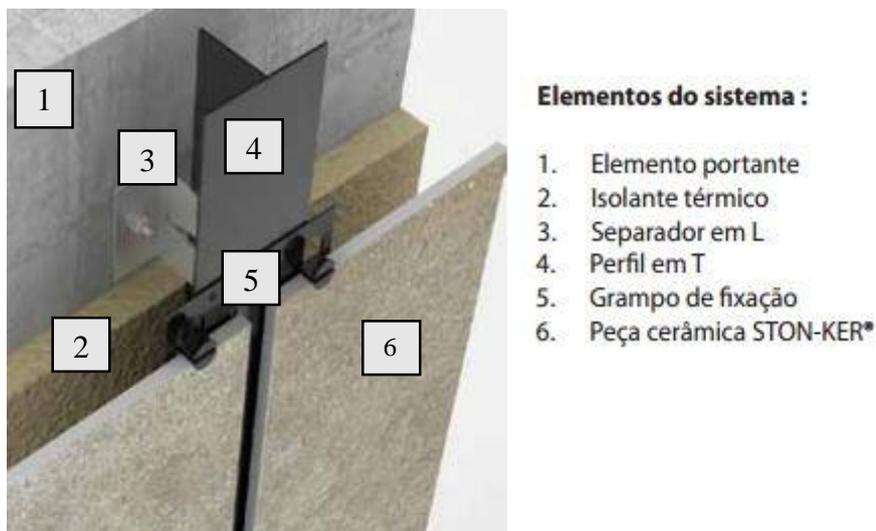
Pormenor de fachada ventilada (fonte: [16])
